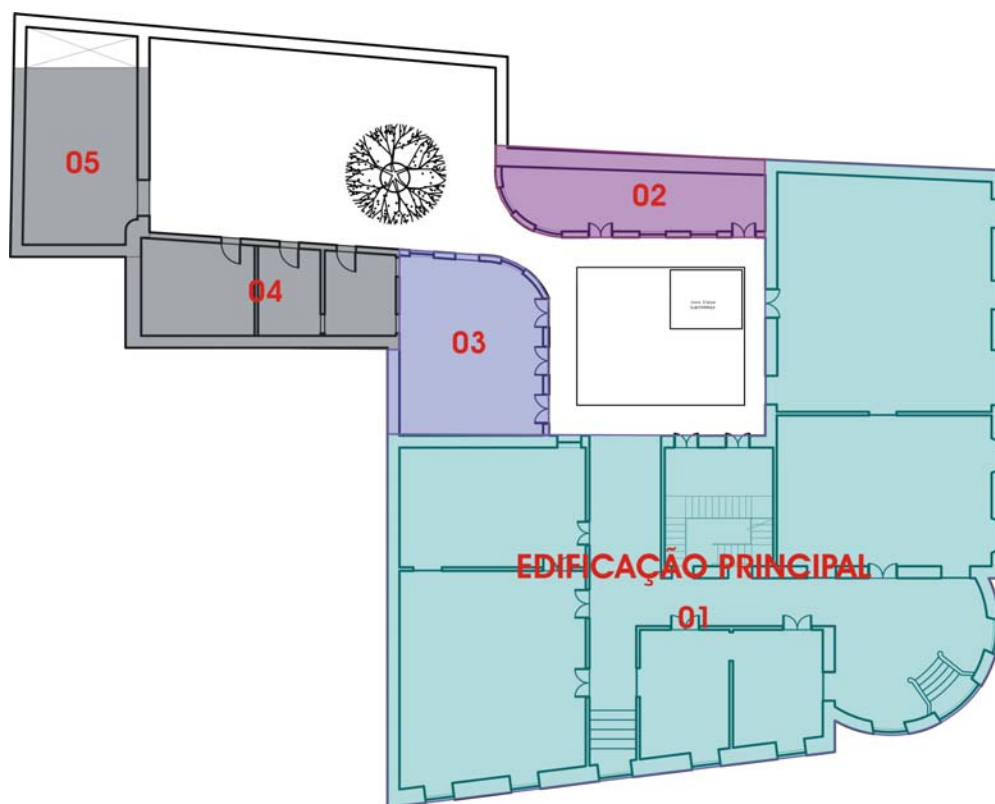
Planta baixa do 1 pavimento, 2009.
